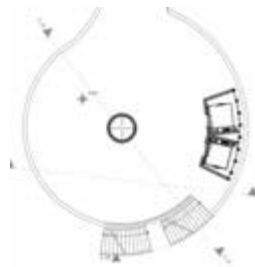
Plaza de acceso 3, planta 2. (+9.45m). (2017)
